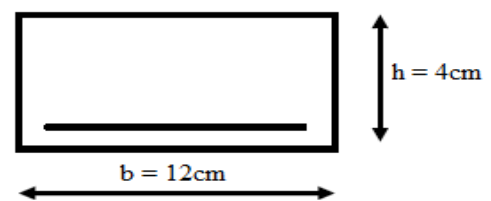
Schéma de la section de la poutrelle avant coulage de la dalle de compression
